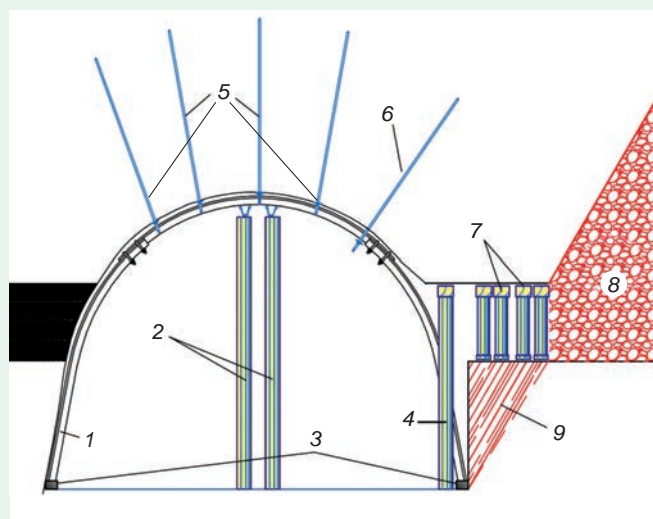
Обобщенный паспорт поддержания выработки за очистным забоем: 1 – арочная крепь; 2 – стойки усиления; 3 – подпятники; 4 – стойка между кровлей и подошвой по бровке лавы, устанавливаемая между рамами арочной крепи; 5 – штанговые анкеры в кровле выработки; 6 – анкеры для поддержания верхнего элемента крепи; 7 – органные ряды; 8 – зона обрушения пород за очистным забоем; 9 – призма сползания пород бровки лавы.
